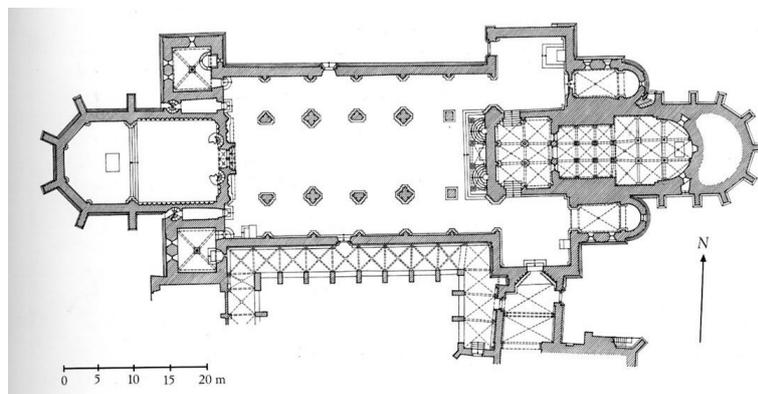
Peter-und-Pauls-Dom, Grundriss, 13. Jh., Naumburg.
